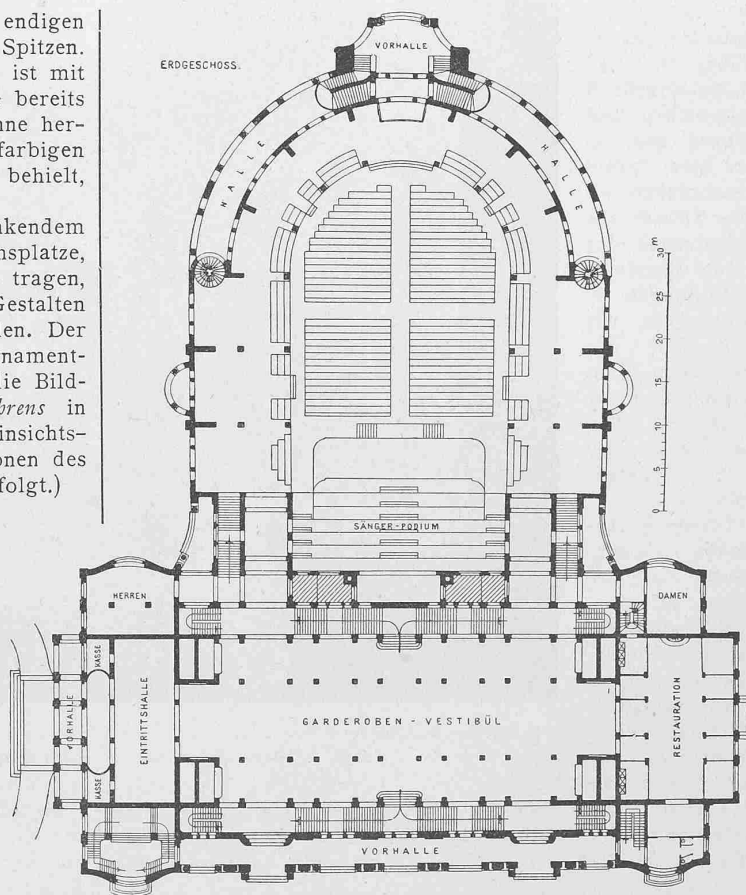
Grundriss vom Erdgeschoss. Masstab 1 : 800.
